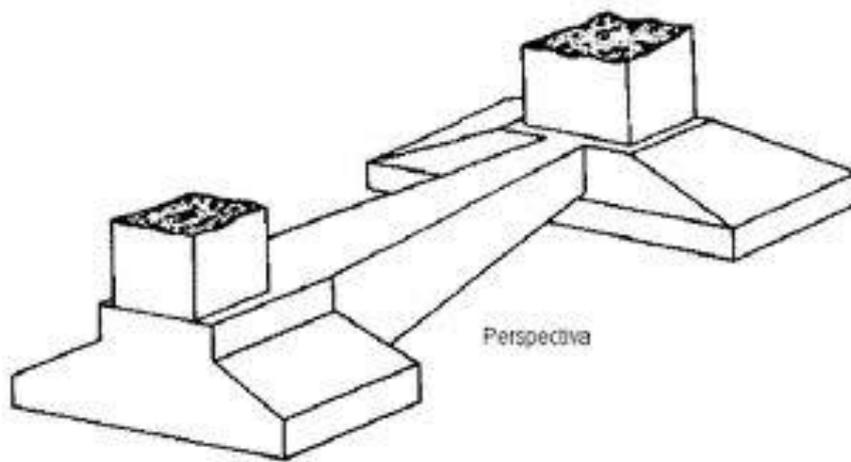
Vigas alavancadas ou de equilíbrio¹¹
